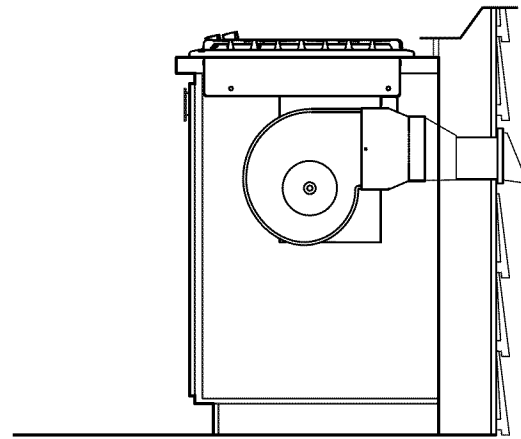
DUCTO QUE ATRAVIESA LA PARED
